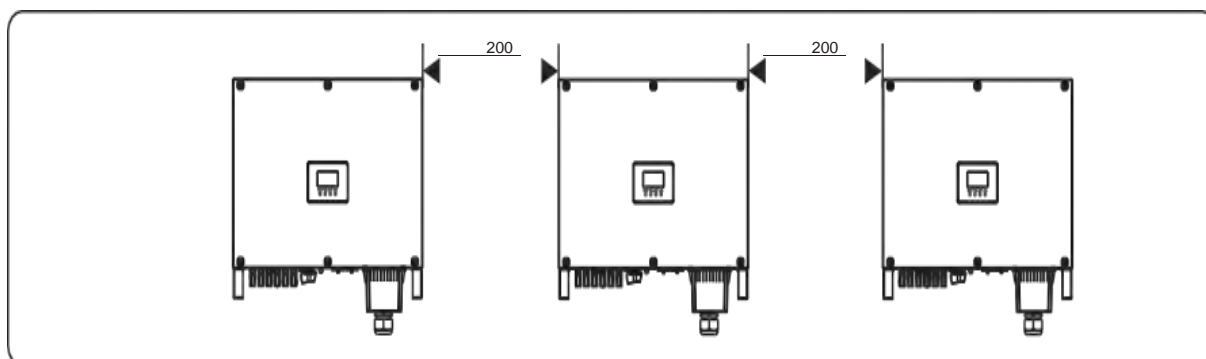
Installazione lungo la stessa linea (unità: mm)
